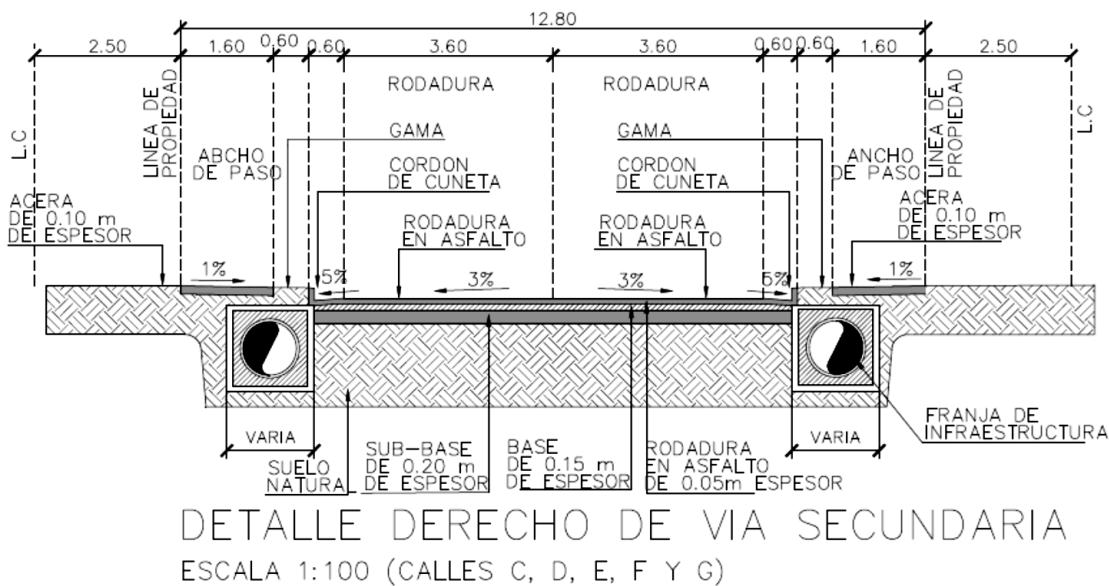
Detalle Derecho de Vía Secundaria (Calles C,D,E,F y G)
